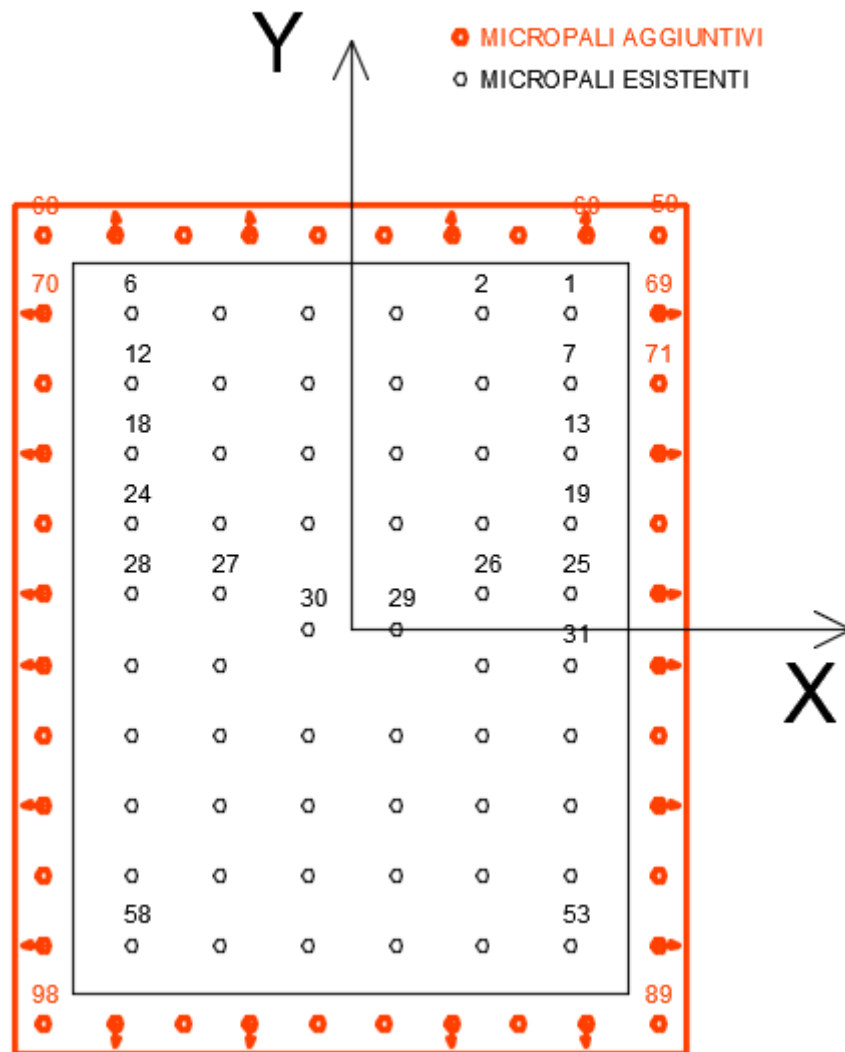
Pila P16 – Configurazione di progetto di miglioramento sismico – pianta
